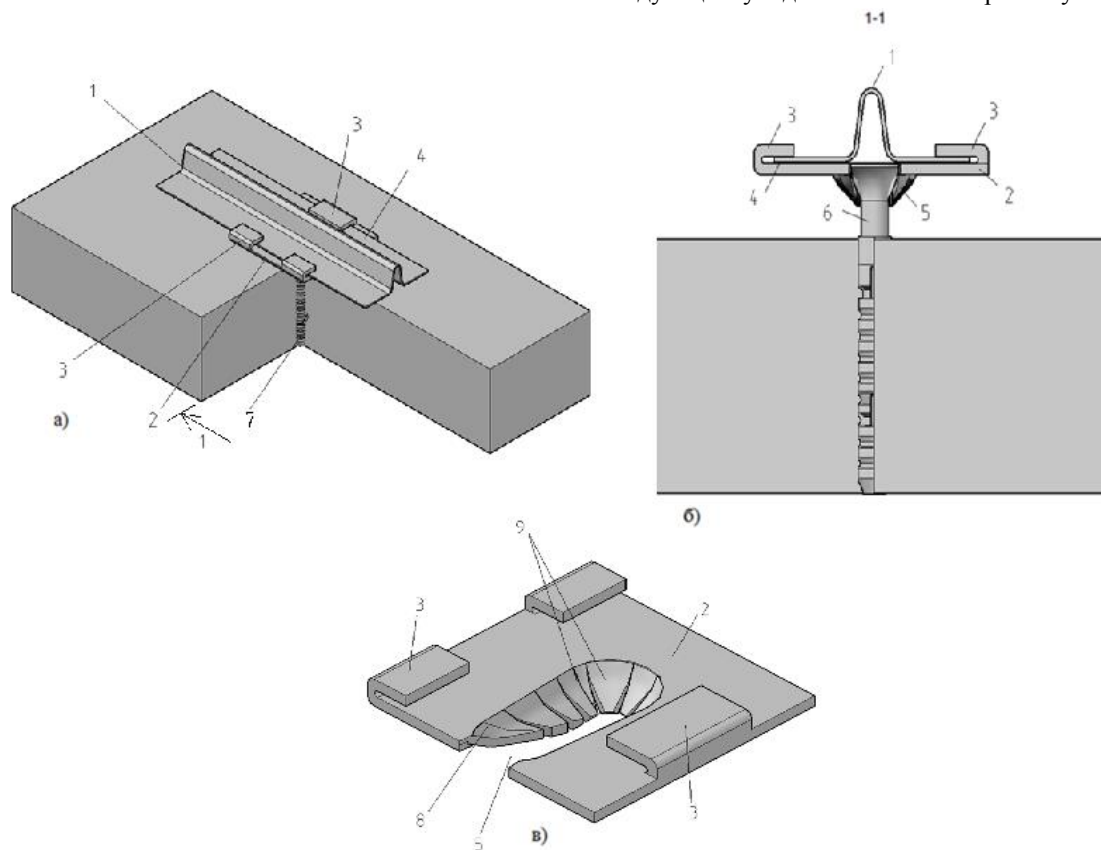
Схема установки и выверки маячкового профиля для последующего бетонирования выравнивающей стяжки под полы или кровли раствором на основе гранул пеностекла: а) - готовая конструкция установленного и выверенного маячка 1 перед бетонированием поверхности; б) - тот же узел, разрез 1-1; в) - поясняет форму и элементы самого держателя 2: 3 – отгибы, 4 – паз под профиль 1; 5 – то же, под шуруп 6; 7 – дюбель, 8 – выштамповка под головку шурупа 6
